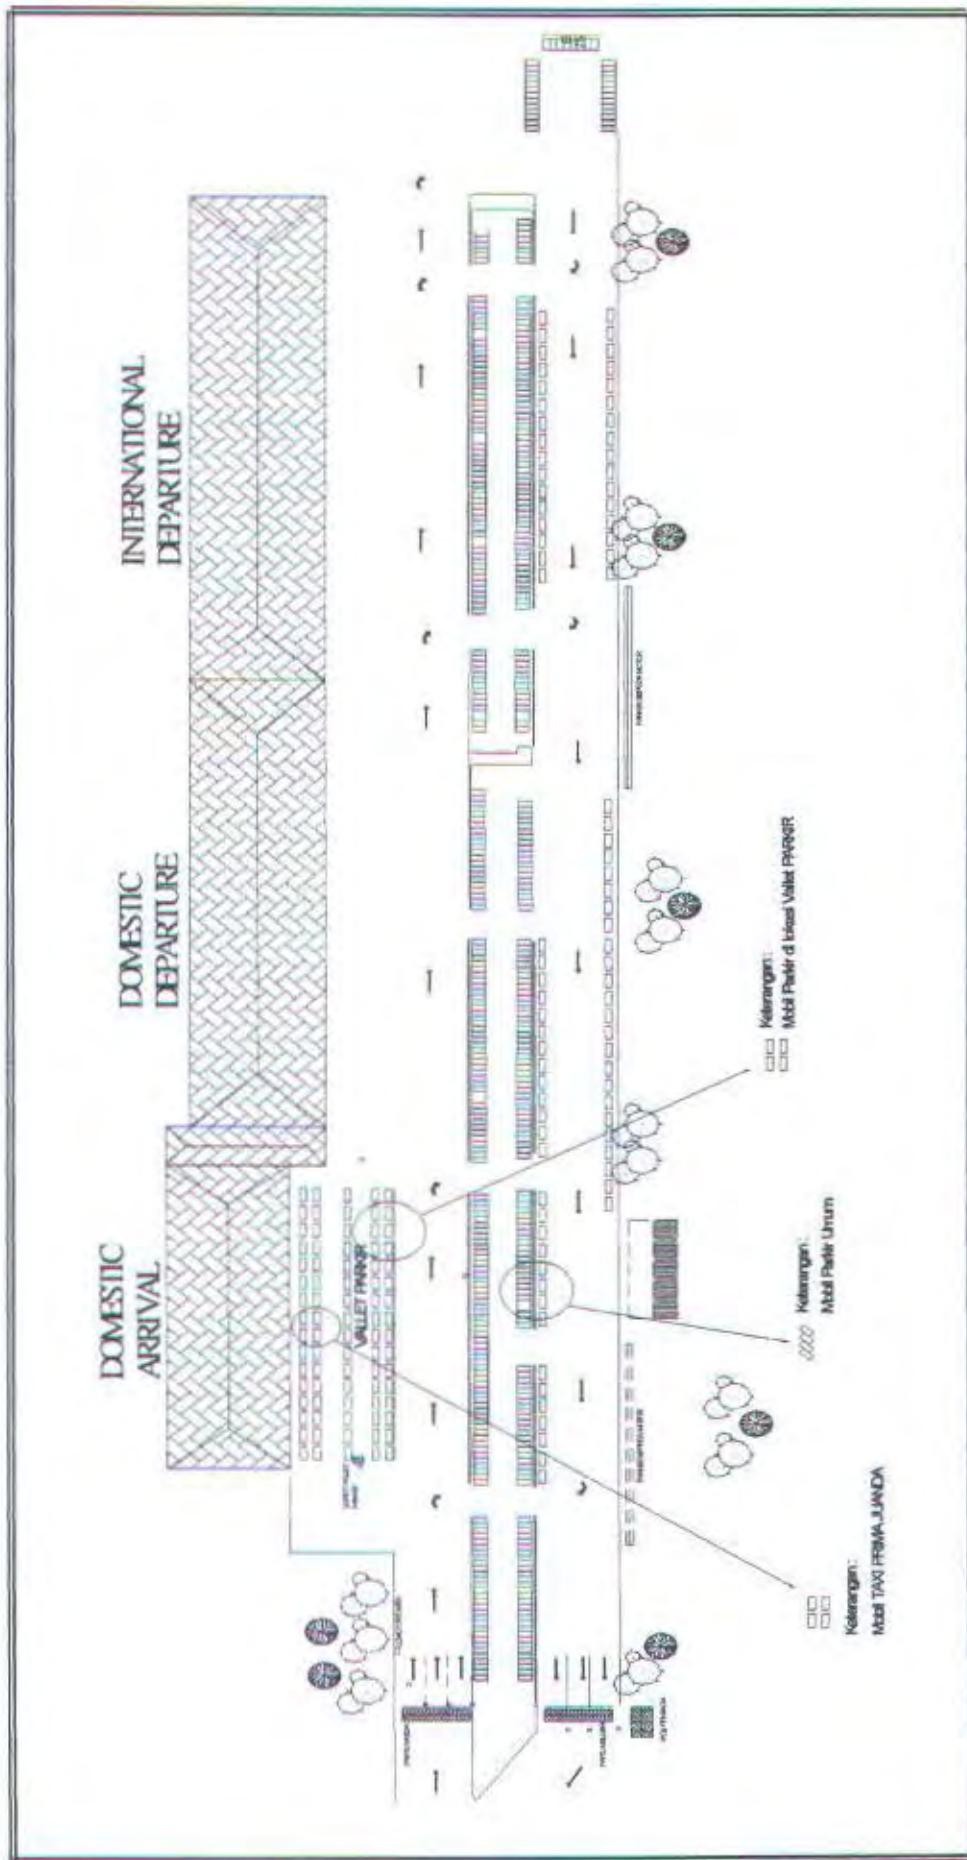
Lay out alternatif 2 lahan parkir Juanda
